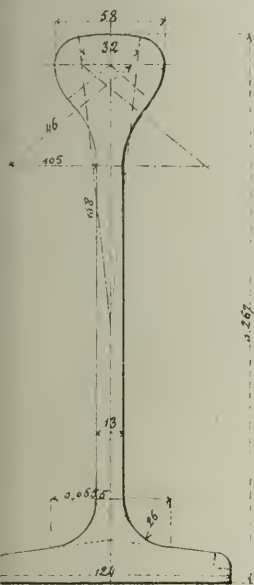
Section du Rail et de l'Eclisse, Const^{on} du Profil
